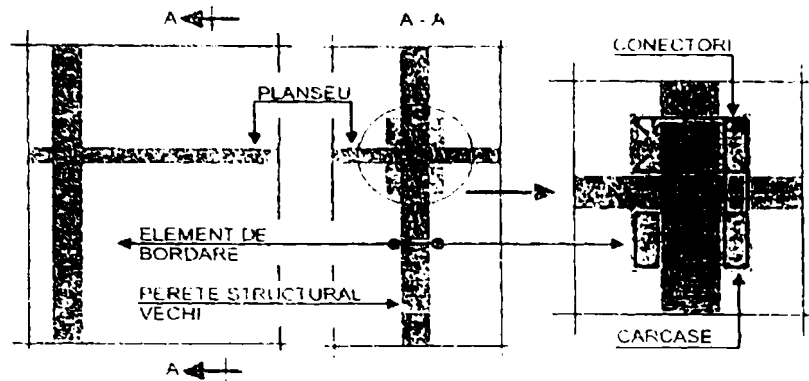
Bordarea peretilor structurali din beton armat.
